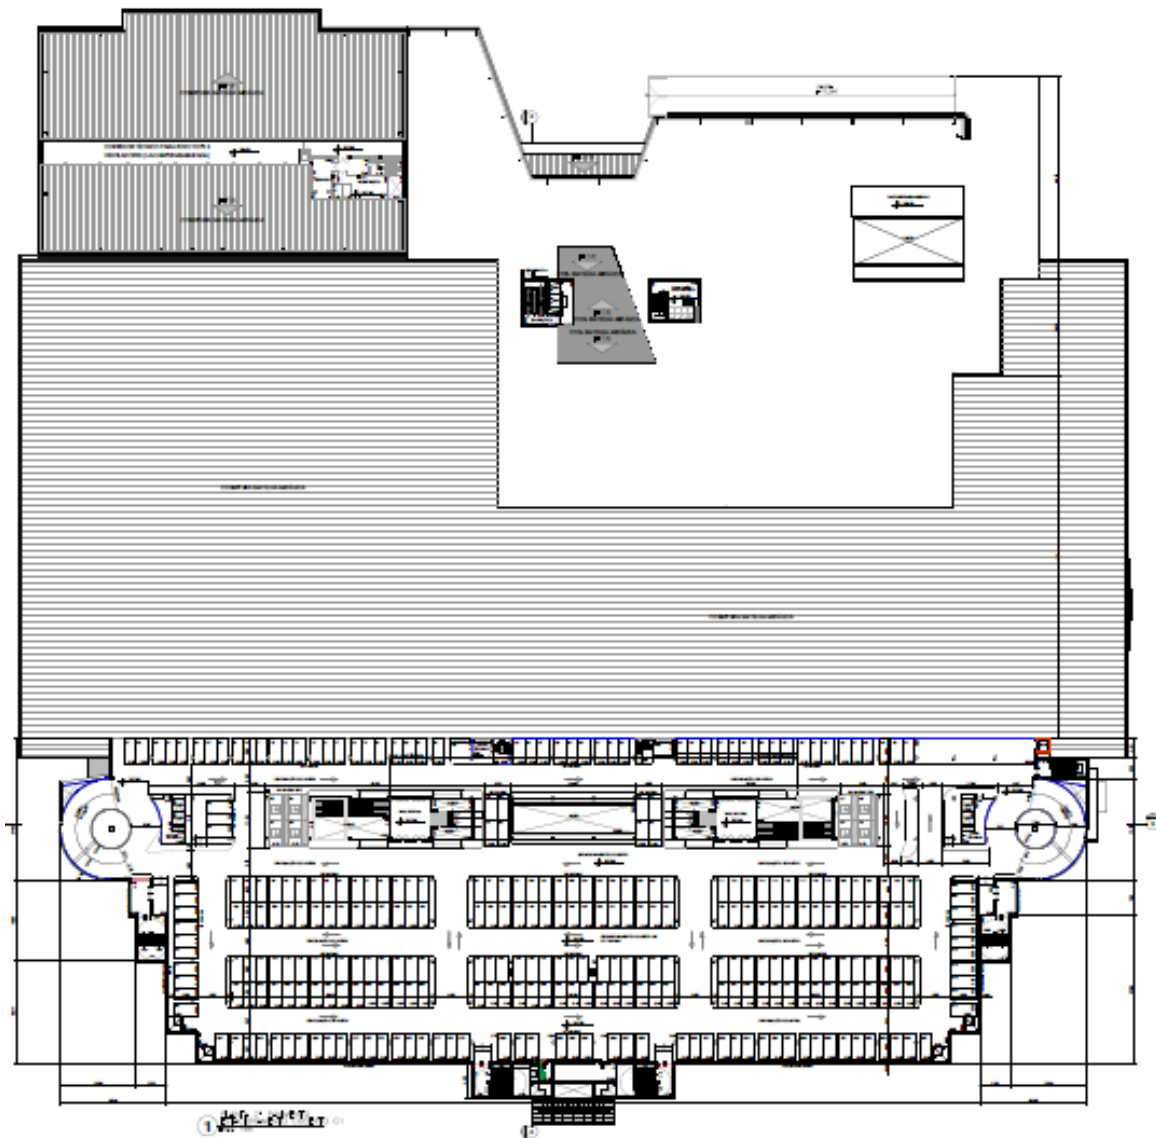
Planta Segundo Pavimento – Estacionamento coberto G1. Fonte: Engexpor.
